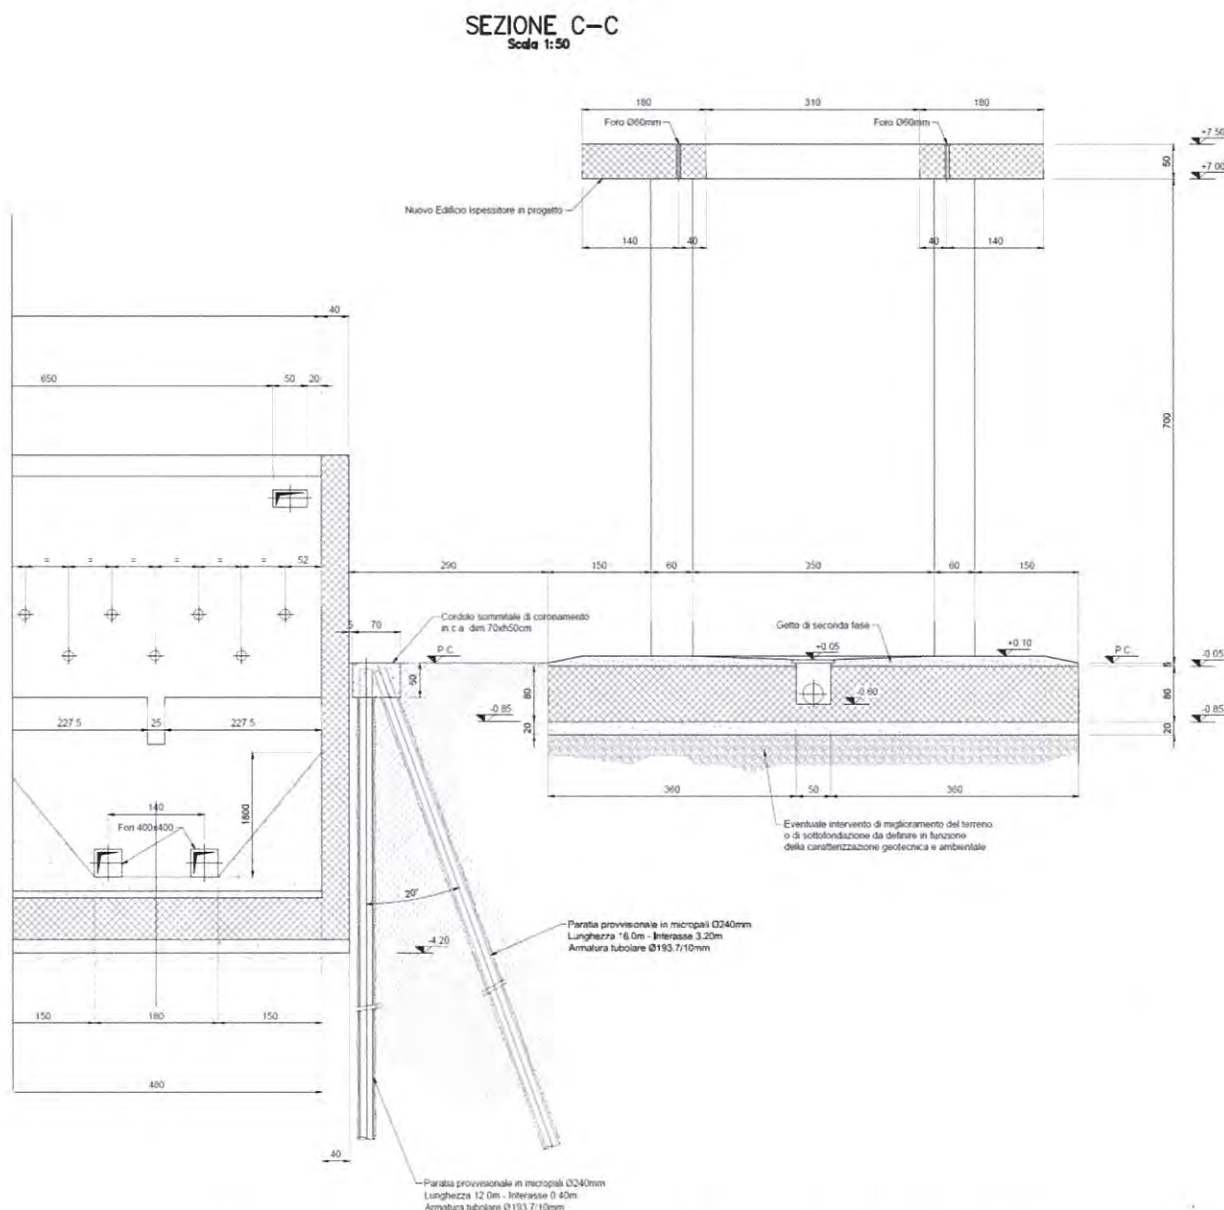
Sezione trasversale scavi zona nuovo ispessitore (Sezione C-C)
